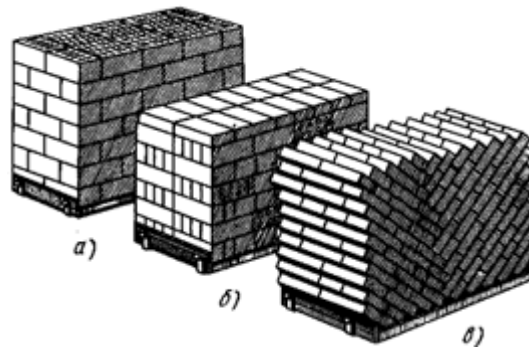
Укладка на поддонах кирпича с перевязкой
